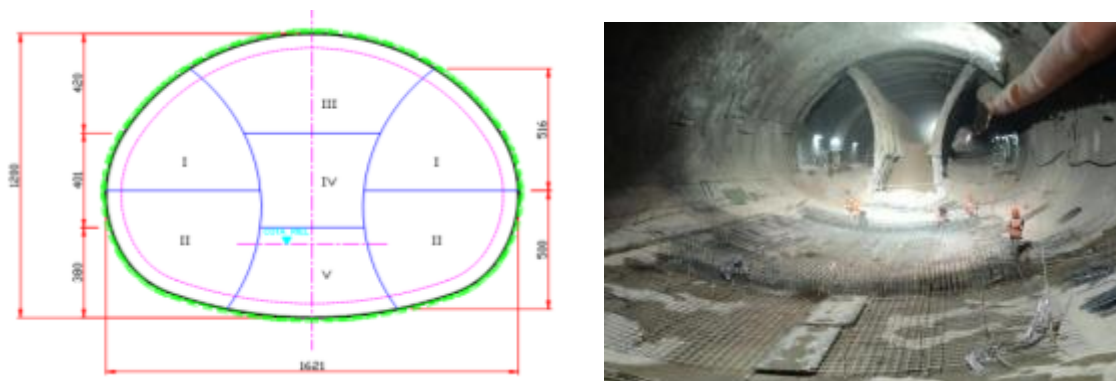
División de la sección completa del túnel excavada en 7 subsecciones de menor área. Ejemplo Túnel Estación Plaza de Armas
